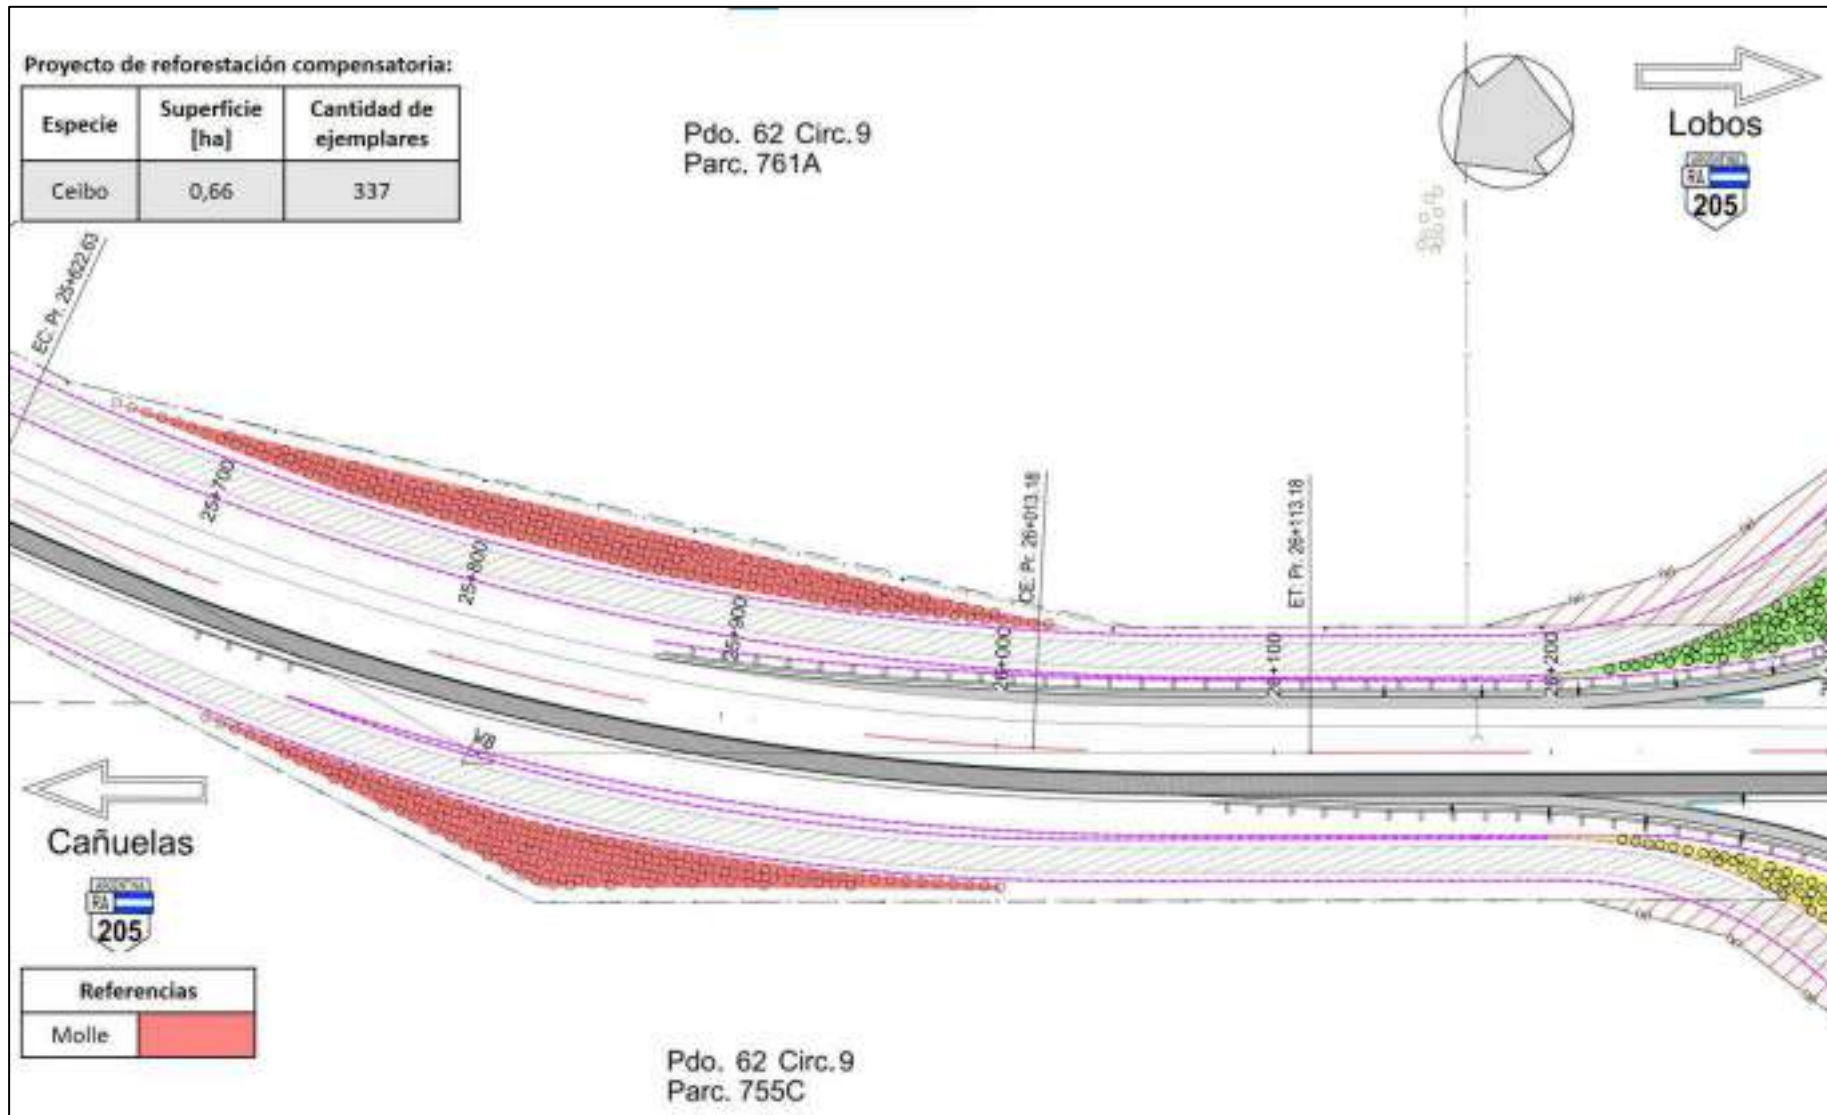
Proyecto de reforestación compensatoria Zapiola (Pr. 26+200 – 26+700)
